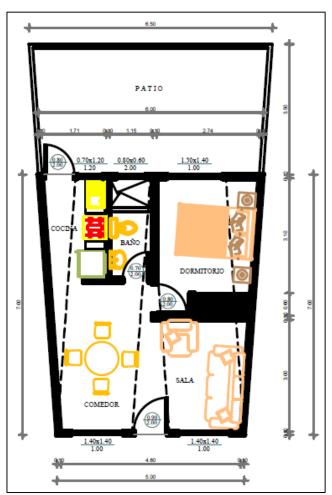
Planta Arquitectónica Fuente: Rosa Guambo Gamarra
